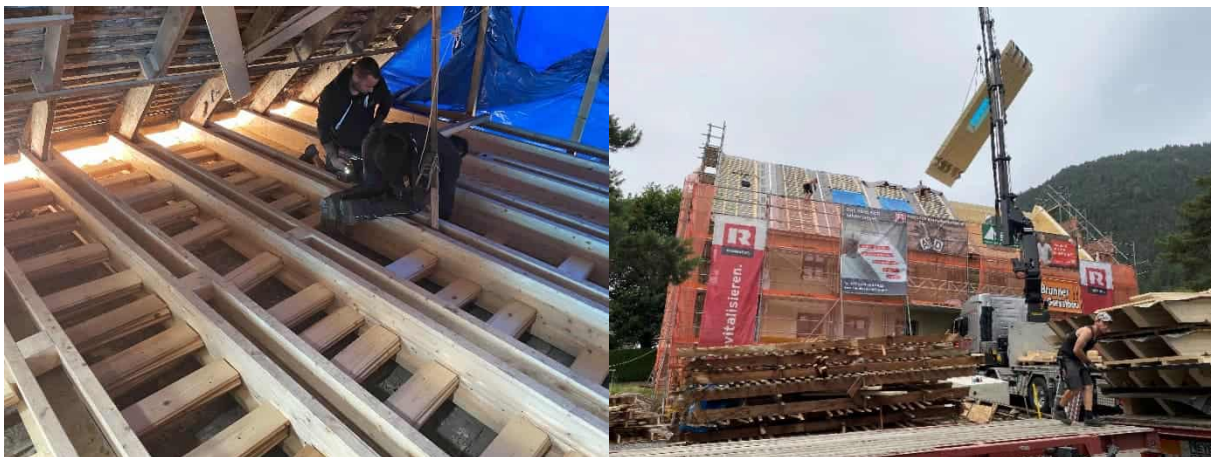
statische Verstärkung der obersten Geschoßdecke und Montage der neuen Dachelemente, kleines Gebäude; Fotos Rhomberg Bau GmbH
